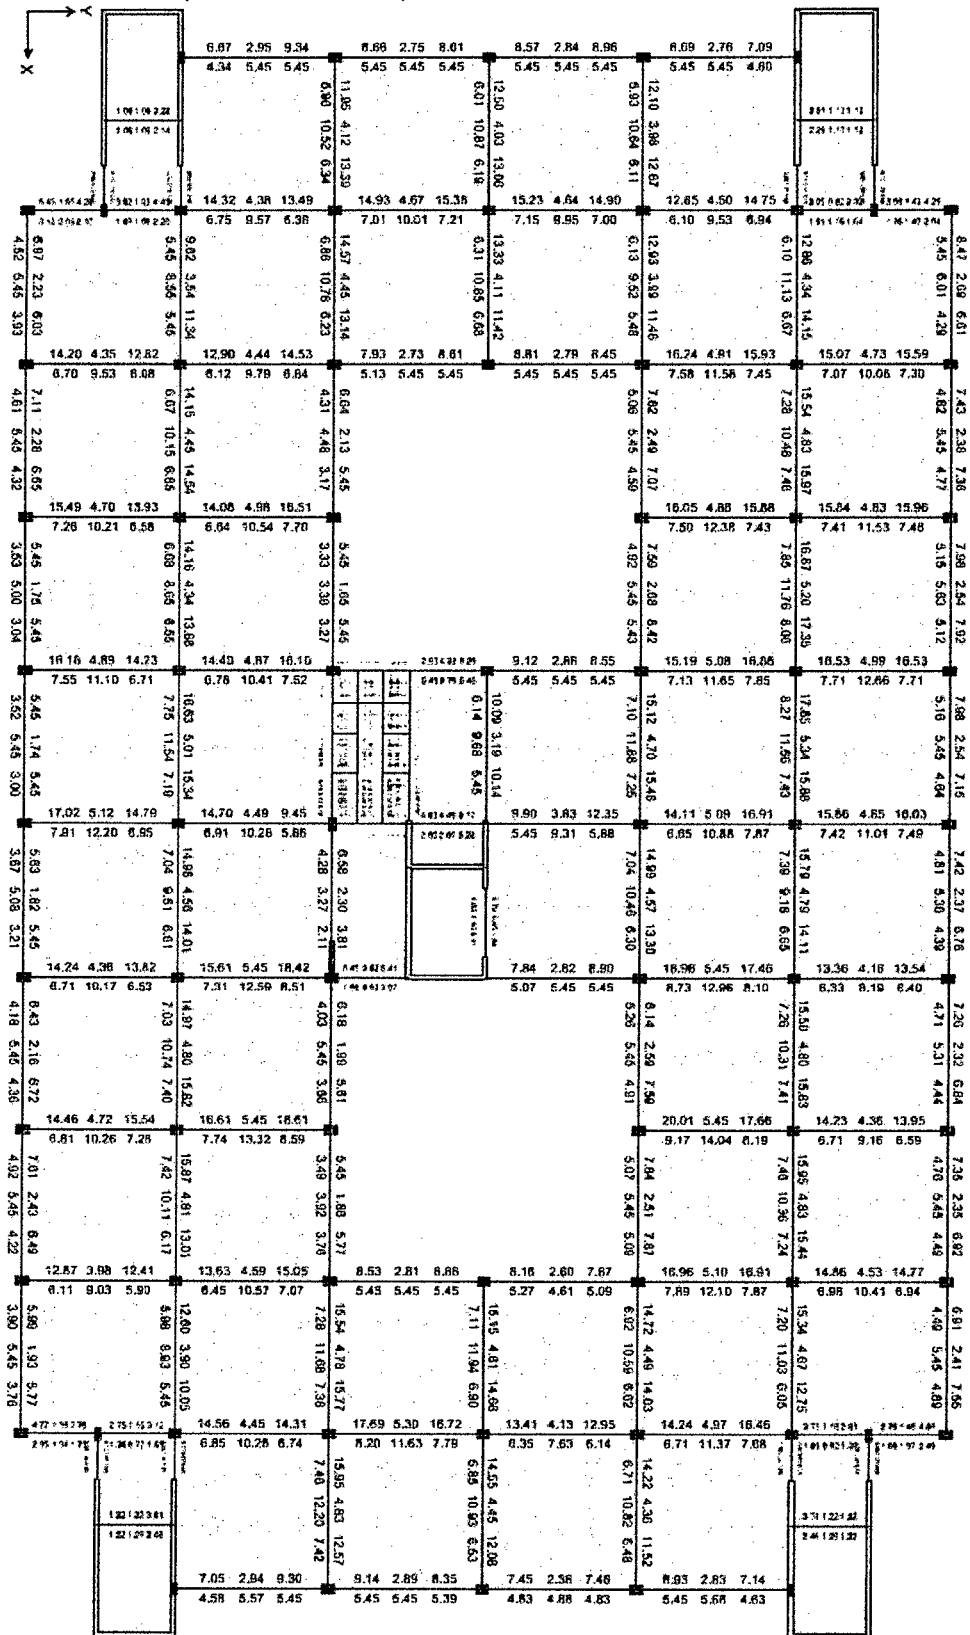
, Estructura aislada, Verificación de elementos estructurales – Piso 1.
